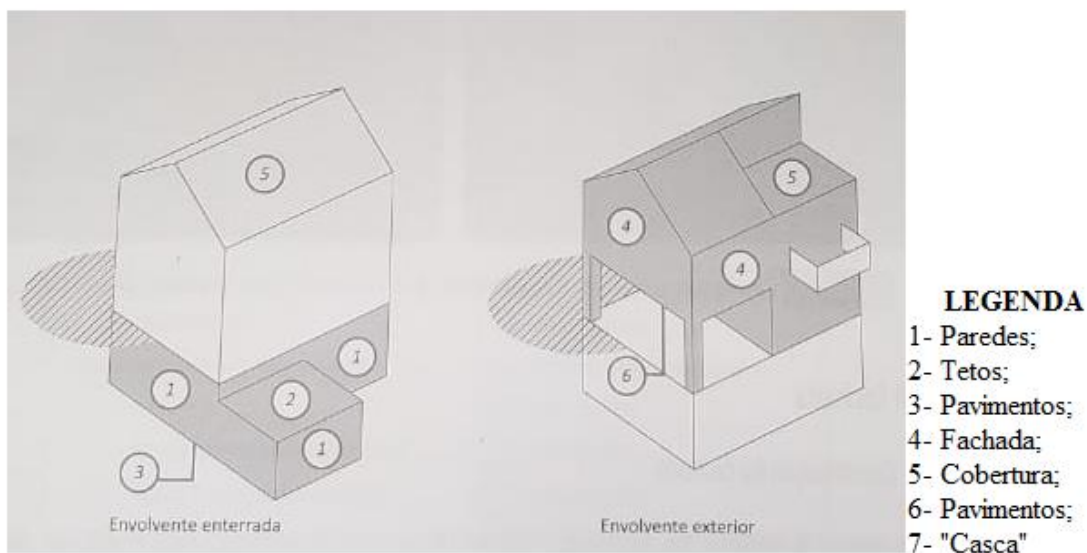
Caracterização da parte externa das edificações. Fonte: SOUSA et al (2016)
